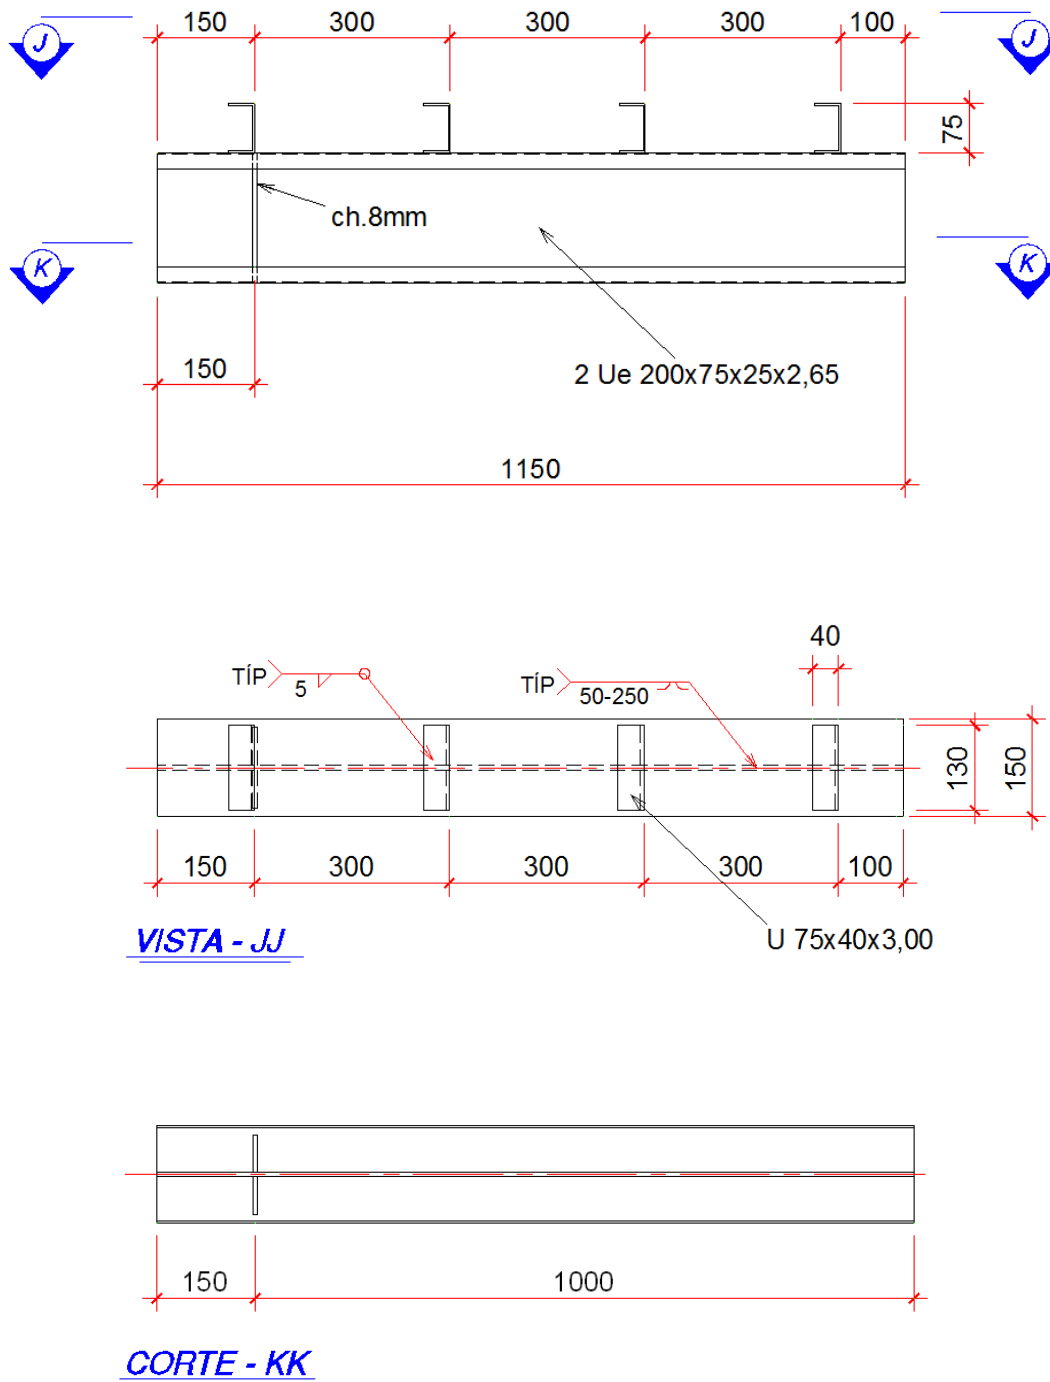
Detalhamento das vigas do modelo soldado
